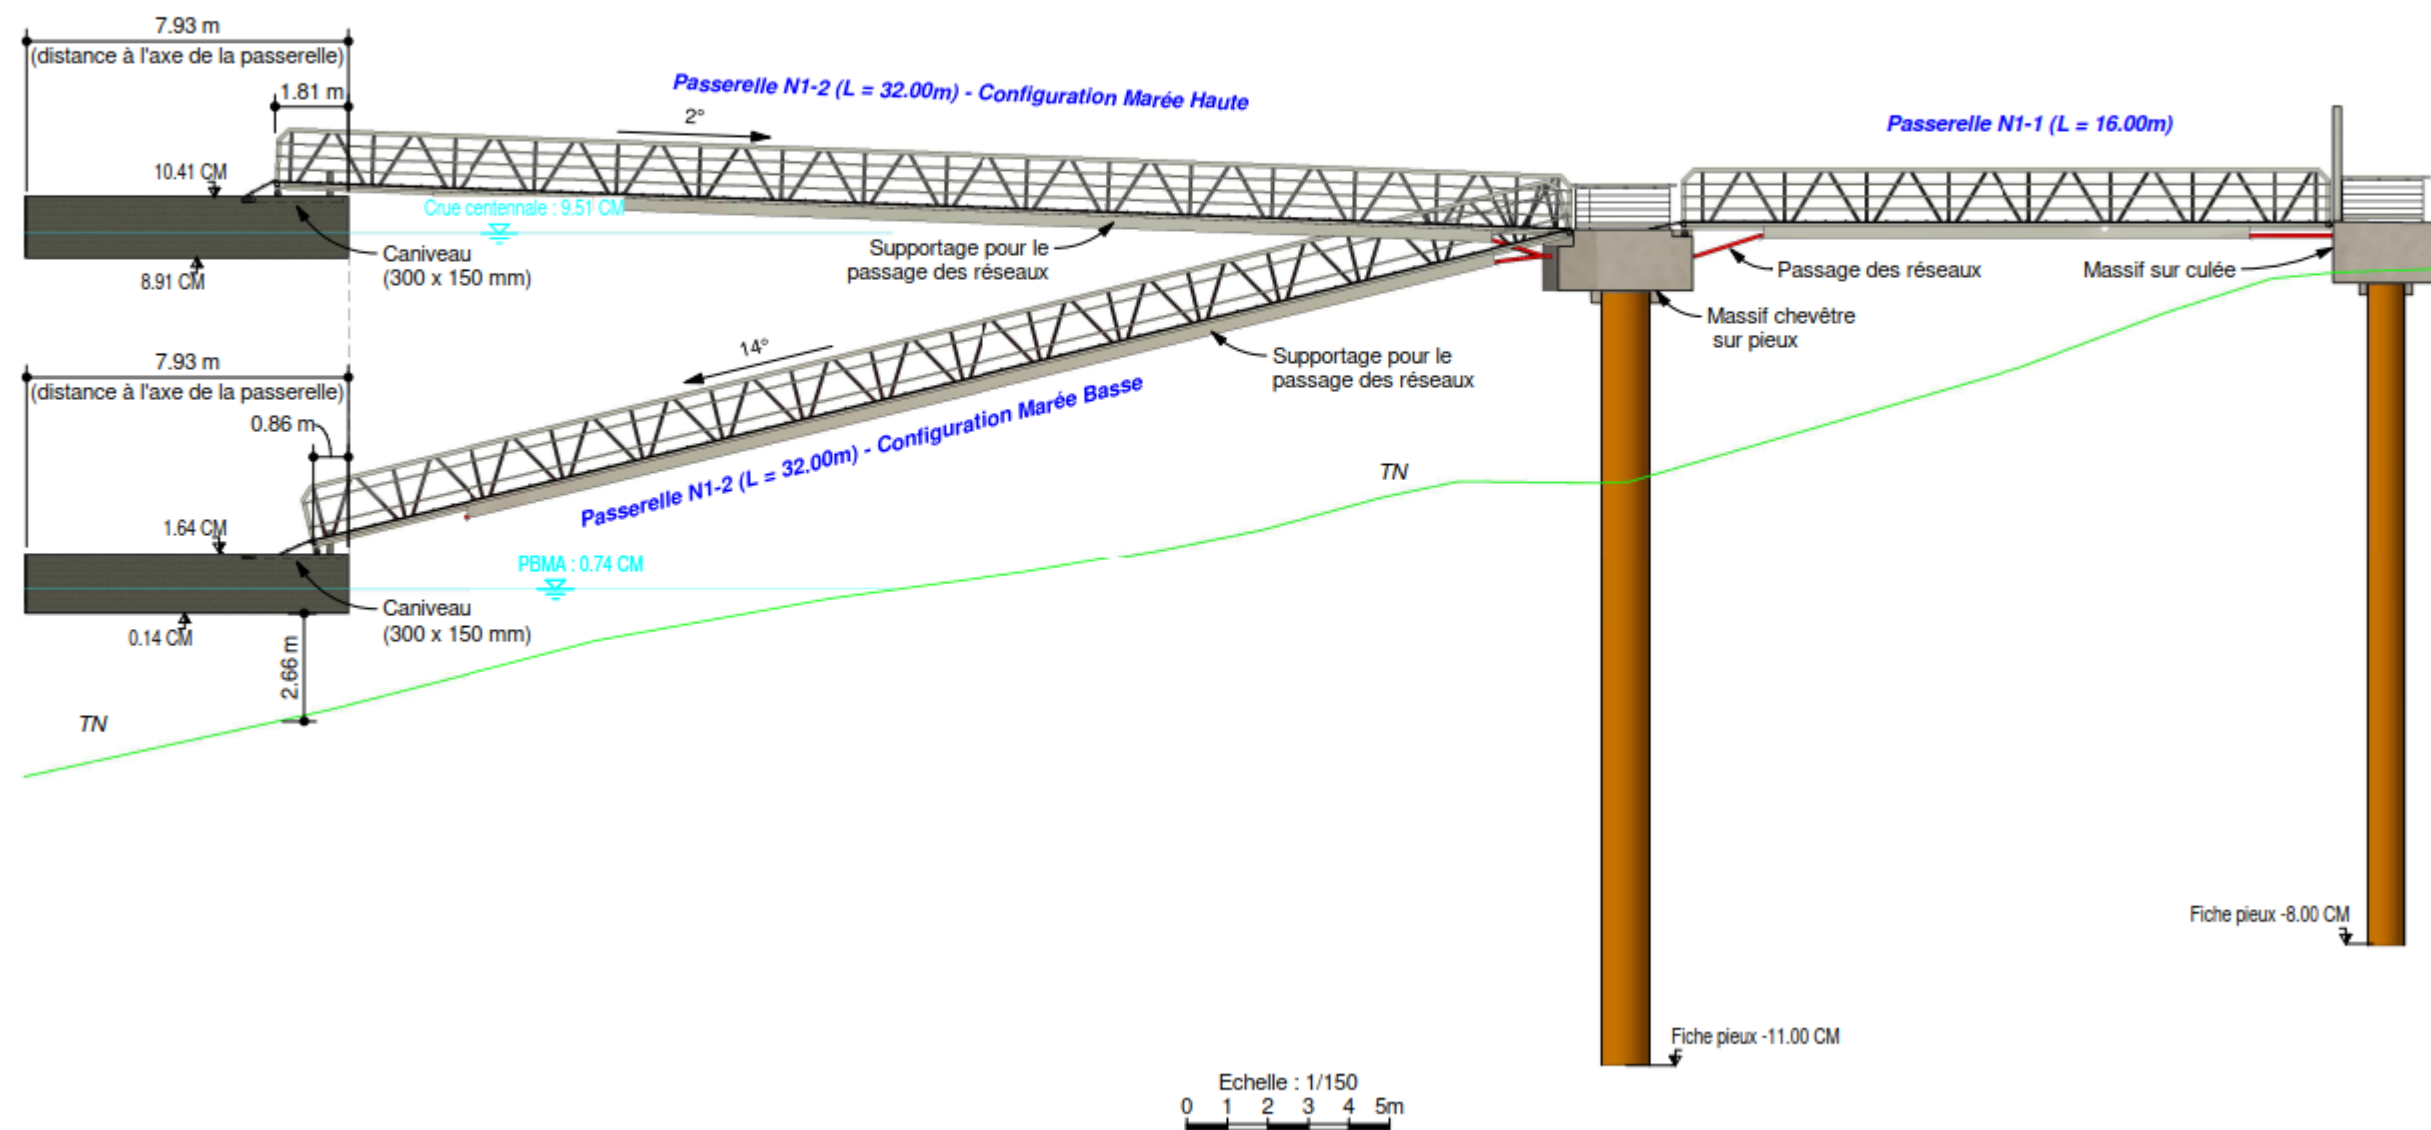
Plan détaillé des passerelles mobiles (Source : AVP)
